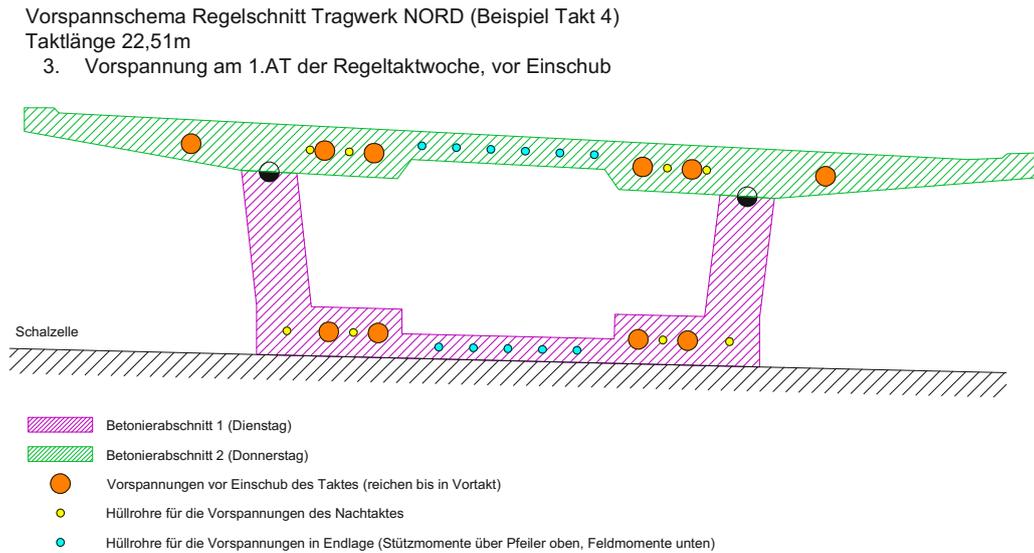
Vorspannschema Ortbetonausführung (Eigene Darstellung in Anlehnung an den ASFINAG Bestandspläne Objekt B2314)
